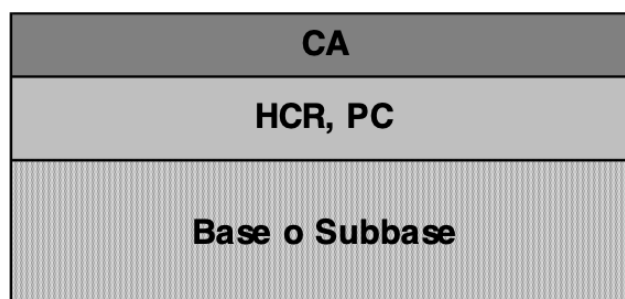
Sección transversal típica #3 de un pavimento compuesto. Fuente: Andrade Triviño y Francisco Puga (2019).
